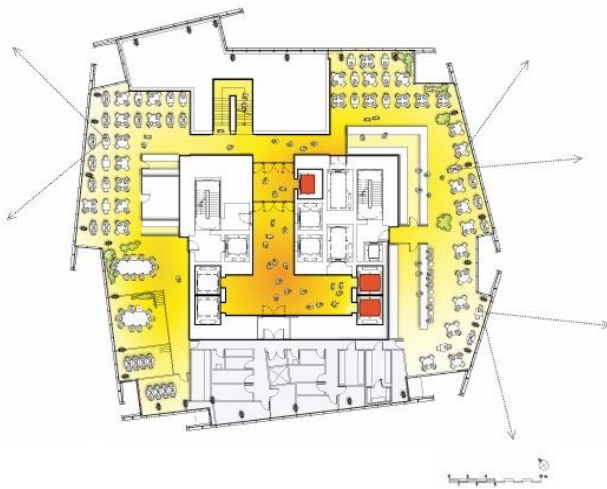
plan de 32<sup>ème</sup> étage ( la piazza de l'air)
